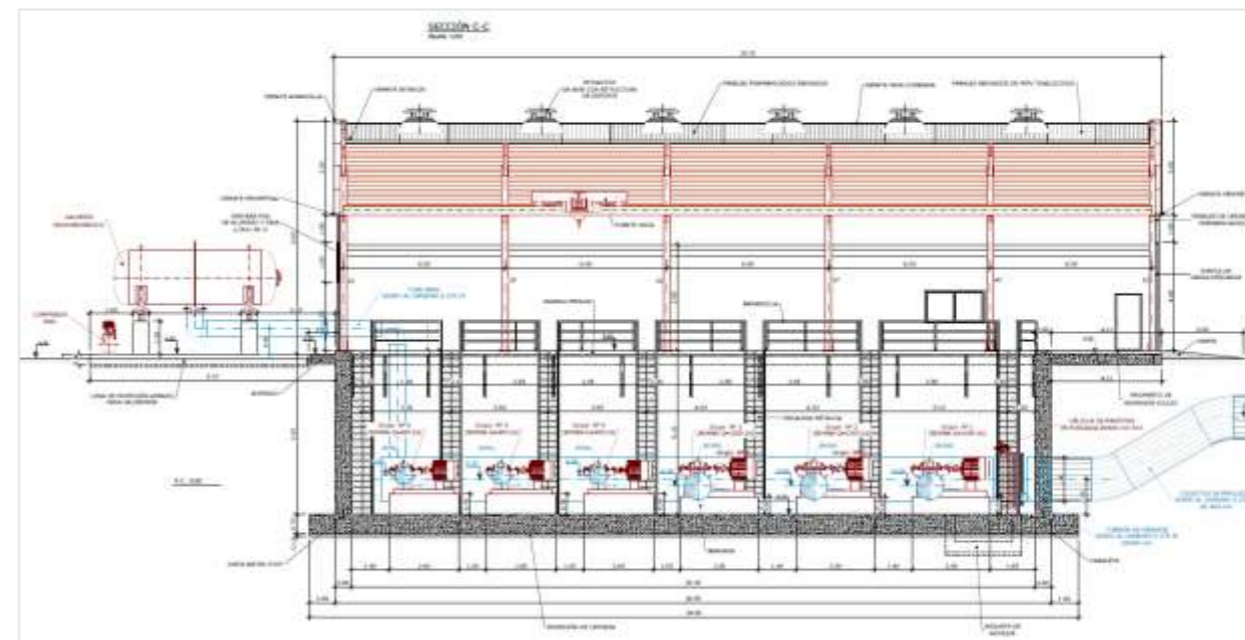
Sección longitudinal de la estación de bombeo a riego. Sector Palmillas
